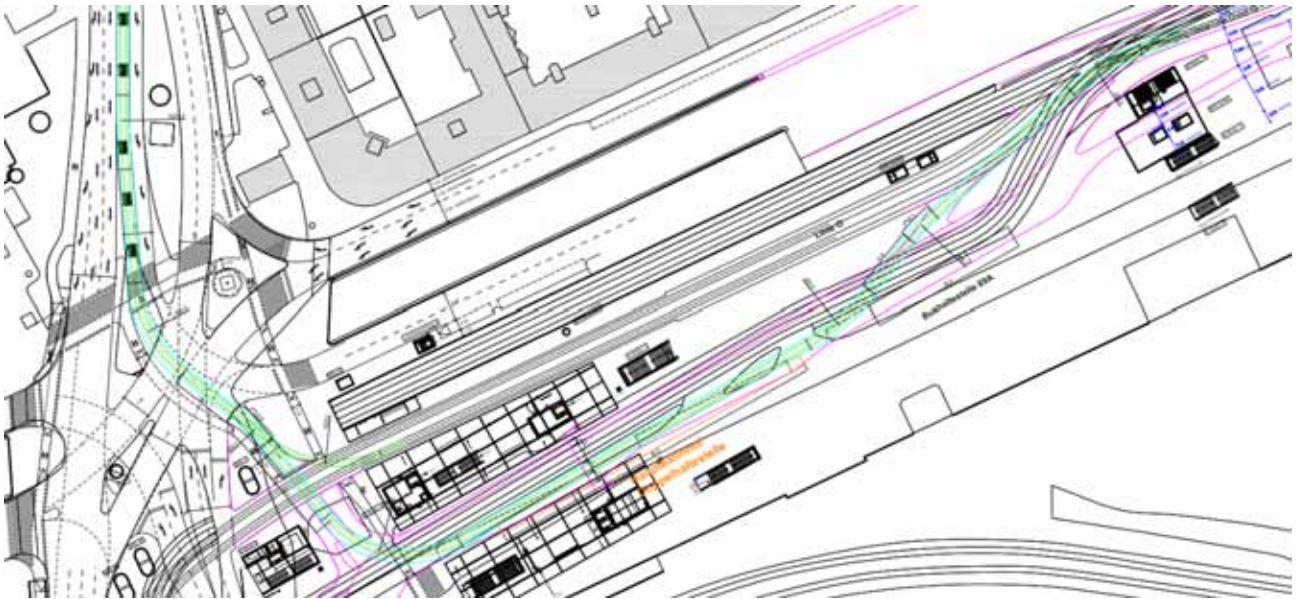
Lageplan Südtiroler Platz bestandsnahe Variante
